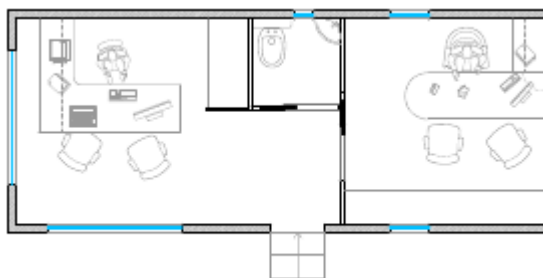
Sistemazione tipologica dei locali da impiantare nelle aree di cantiere
